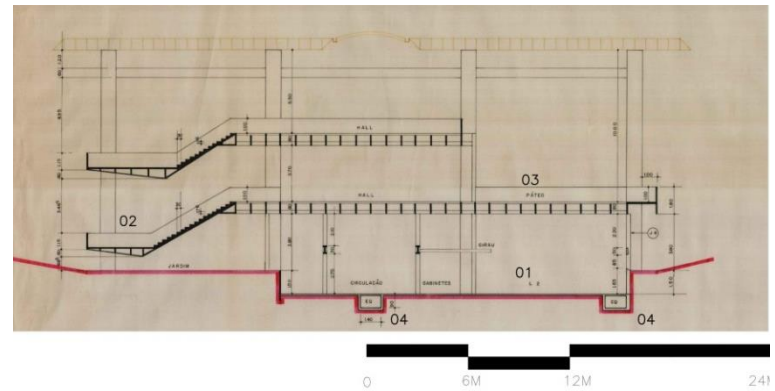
Corte A - Bloco Didático Plano UMA. Fonte: Prancha 15 do Plano de Implantação Imediata – 1º Sub-Etapa Plano UMA – Arquivo digital disponível no COMCAP-UEM.
